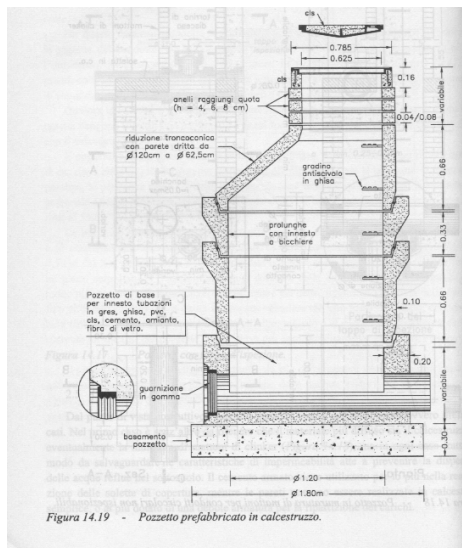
Pozzetto prefabbricato in calcestruzzo.
